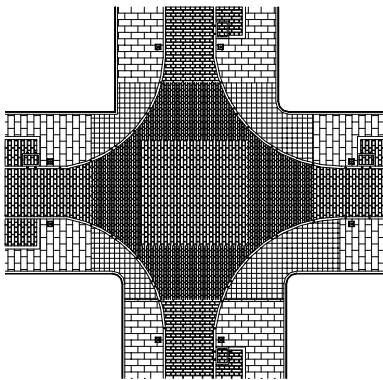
EJEMPLO DE COMBINACIÓN DE PAVIMENTOS EN ENTROQUE TIPO (Fuente: Ayto. de Madrid, Obras de urbanismo e Infraestructuras del barrio de Maravillas y elaboración propia)
